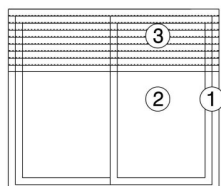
Pormenor de viga inserida em parede de separação com Ina
